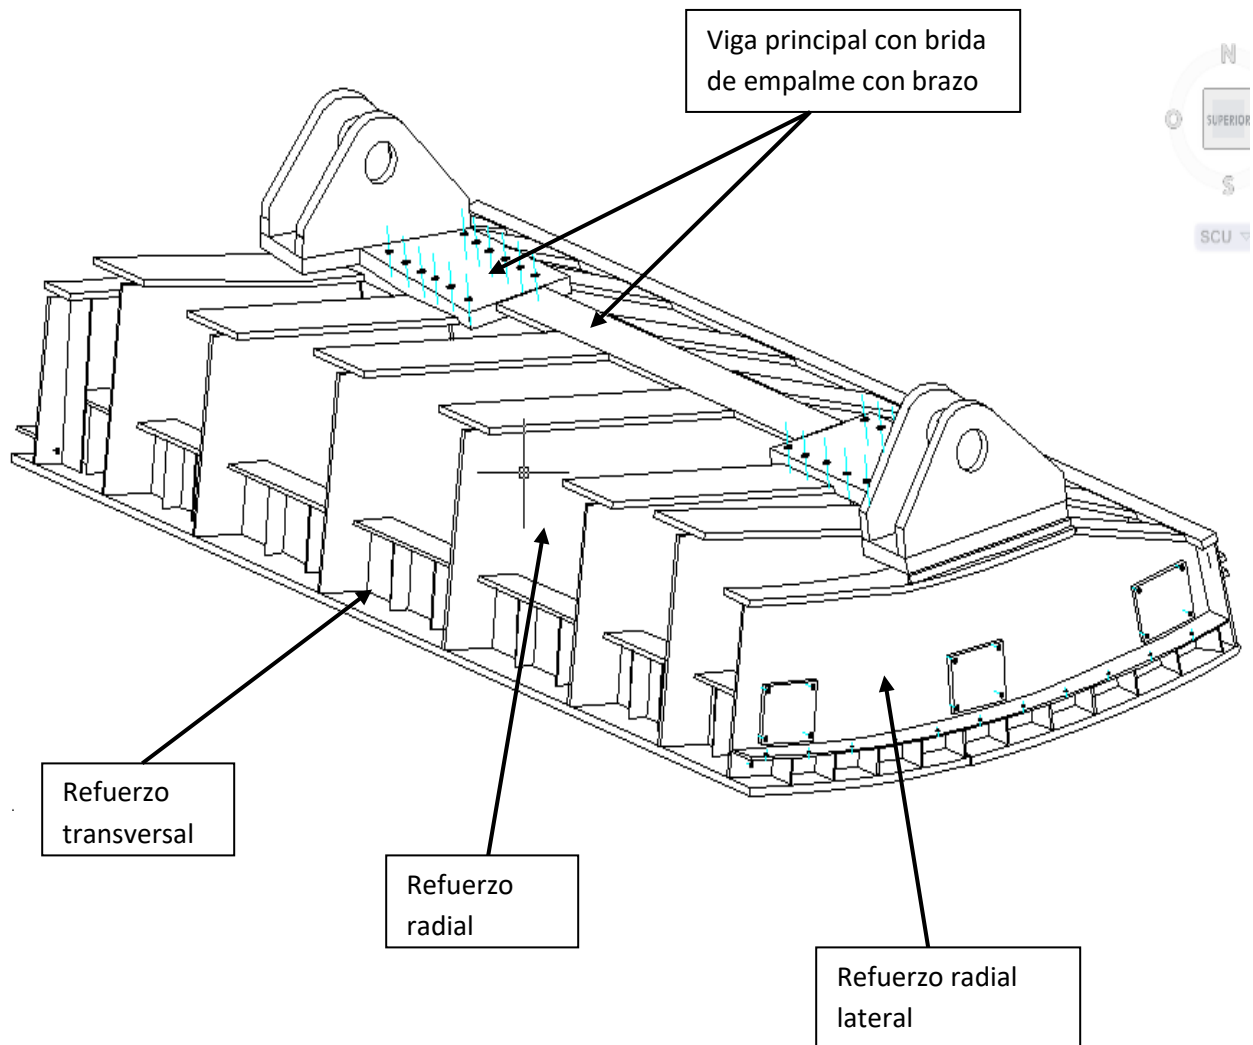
Elementos de compuertas, vigas transversal, radial, radial lateral y viga principal. Fuente: Propia.
